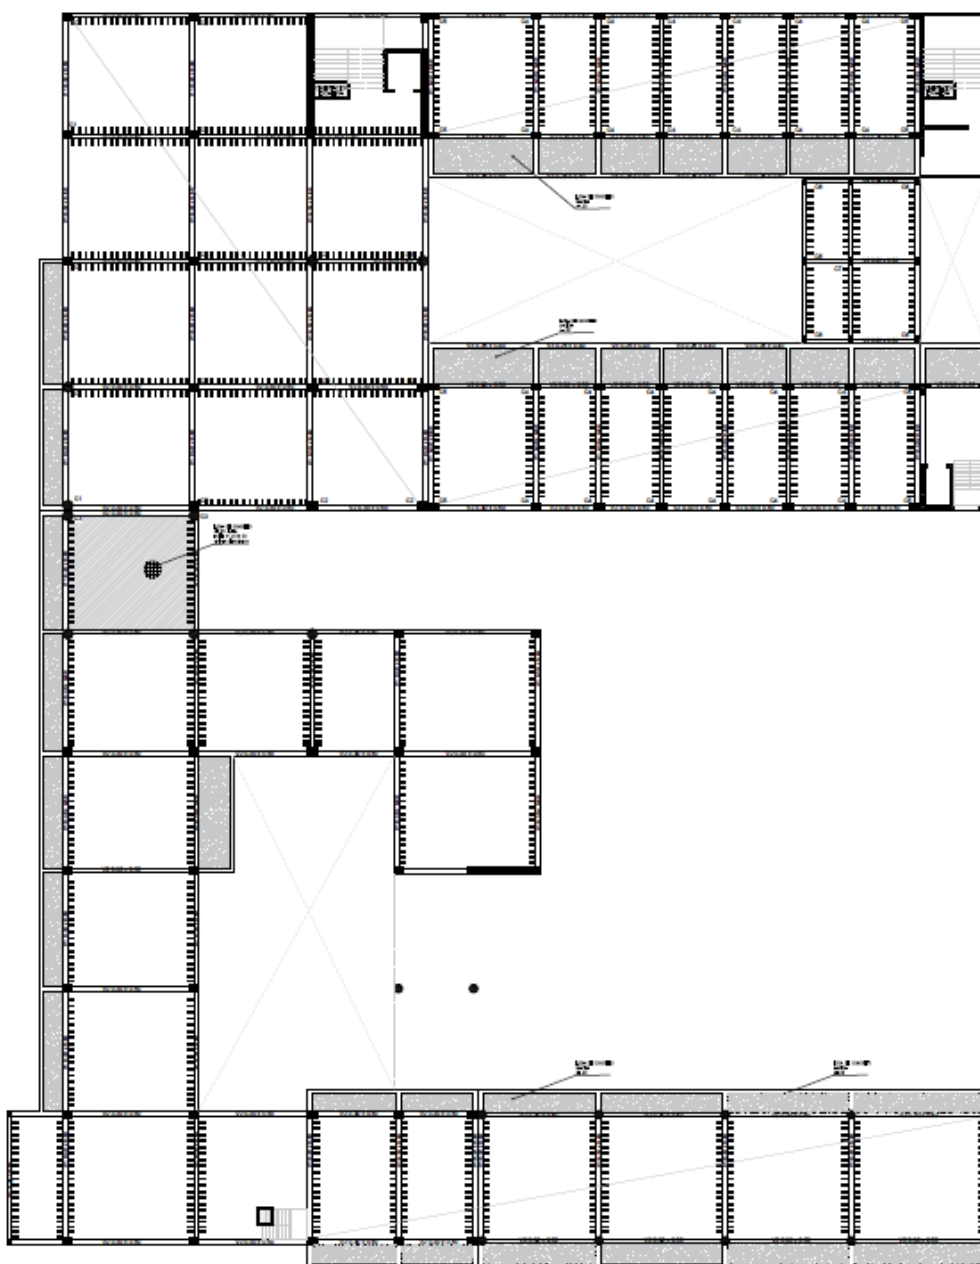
Elementos estructurales – cimentaciones – Bloque CETPRO
